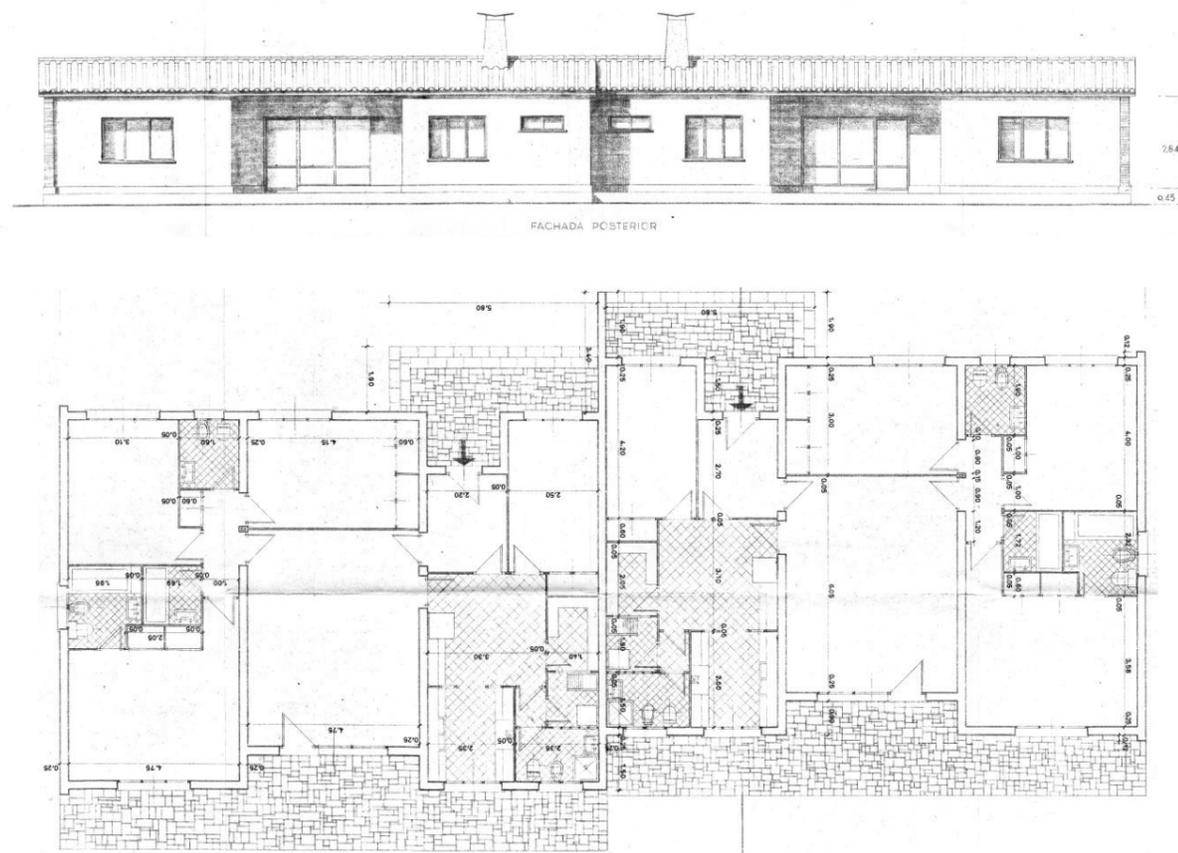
Vivienda de los directivos de Perlofil, de arriba a abajo: alzado sur y planta baja, escala 1:50
